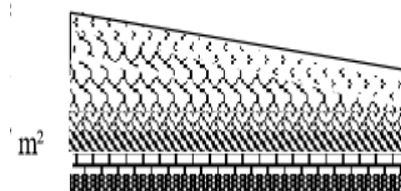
Coupe de plancher terrasse non accessible -corps creux-
